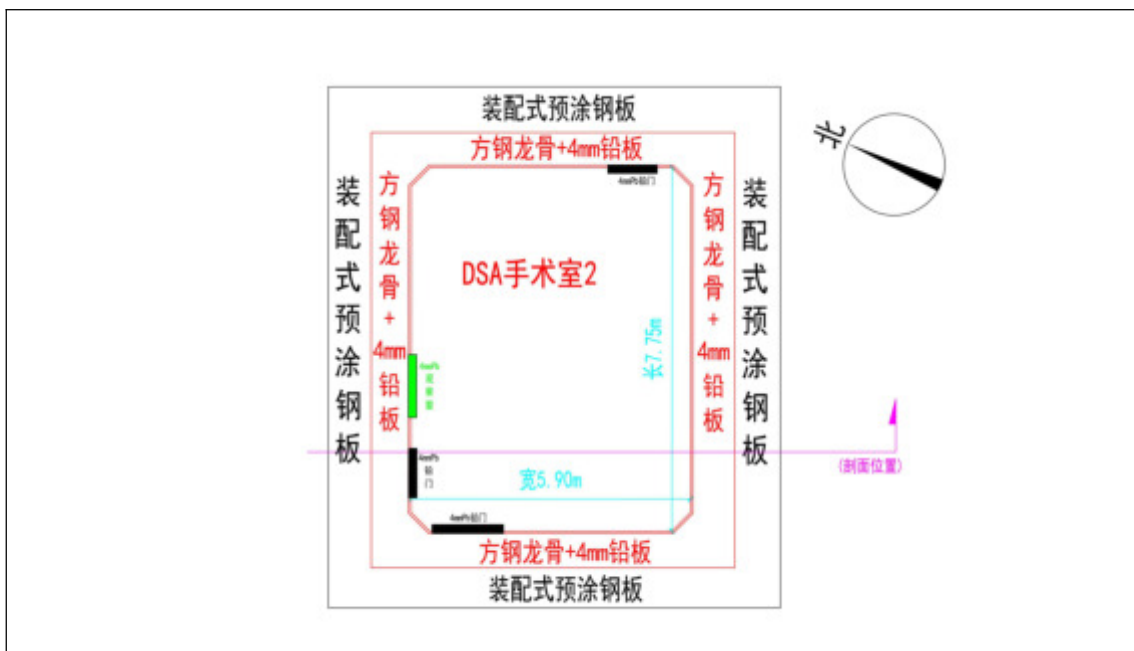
本项目 DSA 手术室四周墙体防护结构平面图
